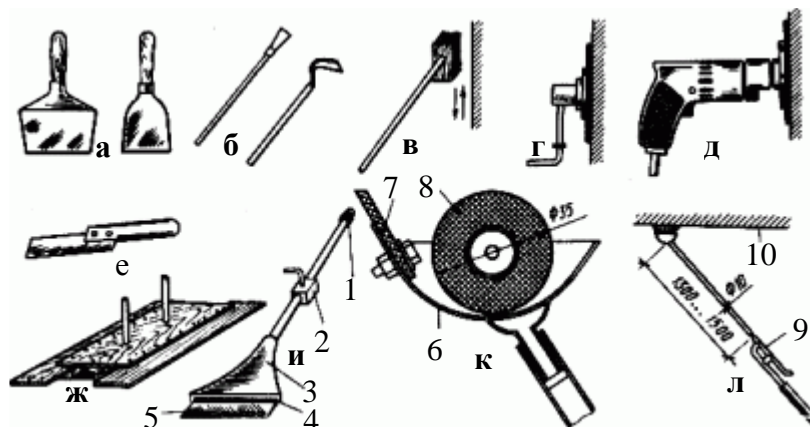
Інструмент і засоби малої механізації для підготовлення поверхні під забарвлювання: а – сталеві шпателі; б – скребачки; в – щітка; г – пневматична затирно-шліфувальна машинка; д – те саме, електрична; е – малярський ніж; ж – шпатель-напівтерток; и – механізований плоский шпатель; к, л – схеми процесу вирівнювання поверхні механізованим шпателем-валиком; 1 – штуцер; 2 – запірний кран; 3 – корпус; 4 – щілина для шпаклівки; 5 – гумова пластинка; 6 – ванночка; 7 – розрівнювальна смужка; 8 – валик; 9 – клапан; 10 – стеля
